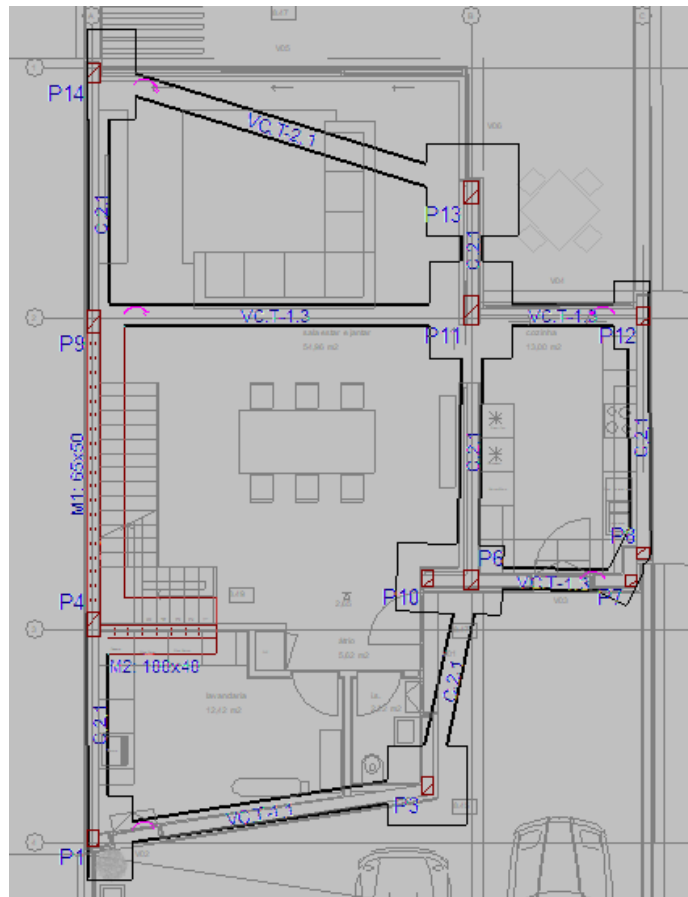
Planta da Fundação (Fonte: CYPE)
